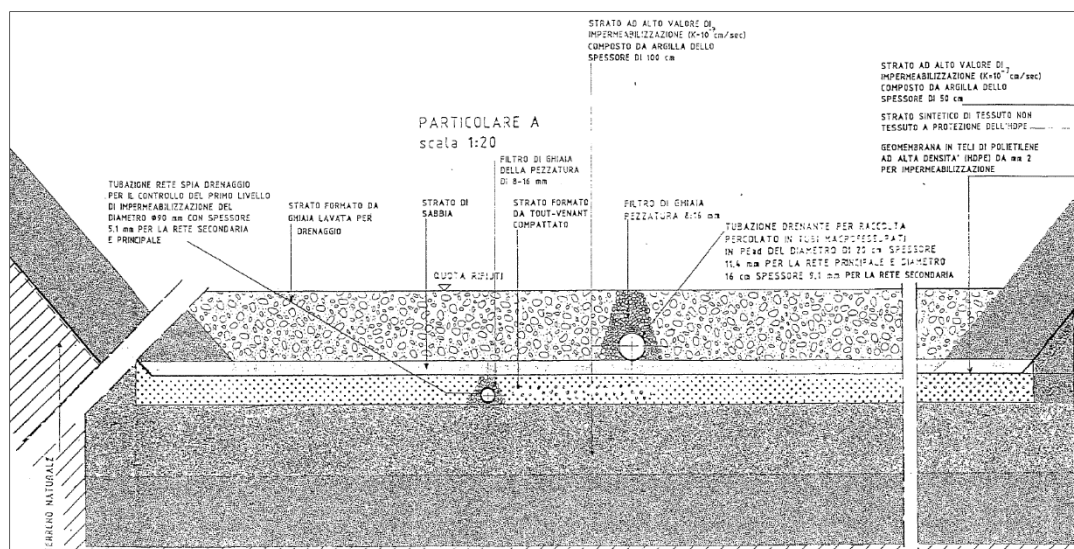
Estratto dal progetto della discarica relativo alla barriera di fondo e laterale
